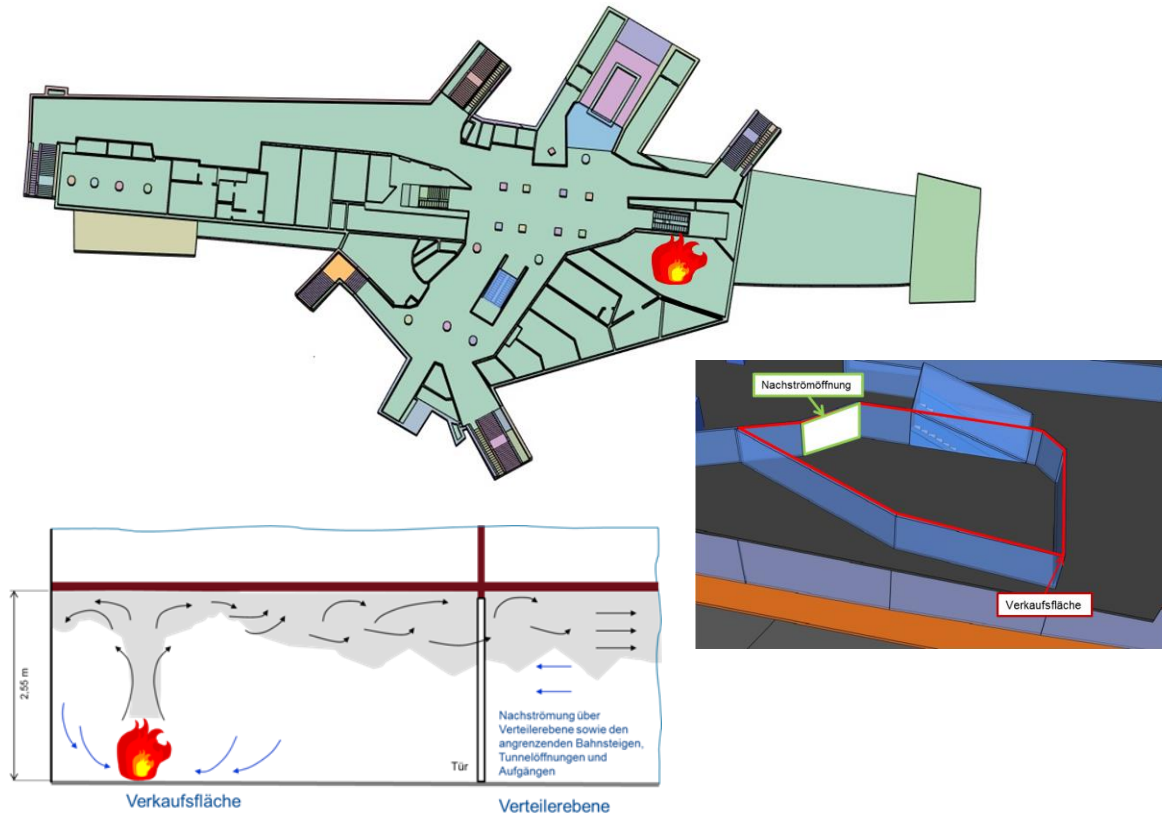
Position des Geschäftsbrandes im Grundriss der Verteilerebene
